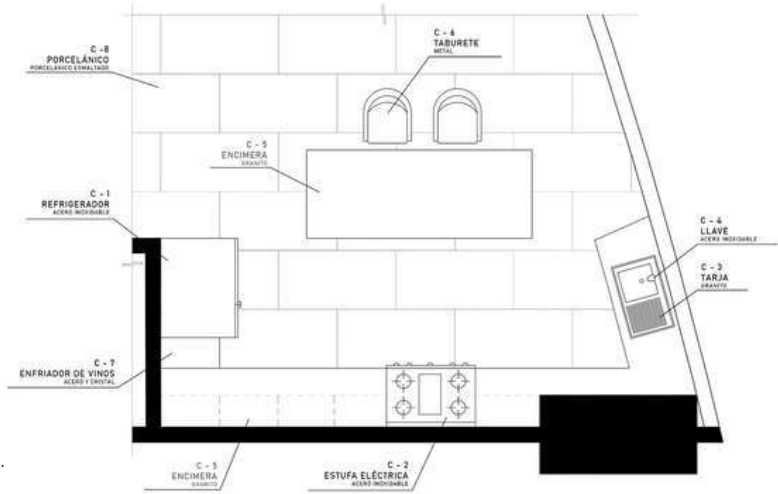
Planta de cocina mobiliario. Fuente: Autoría propia.
